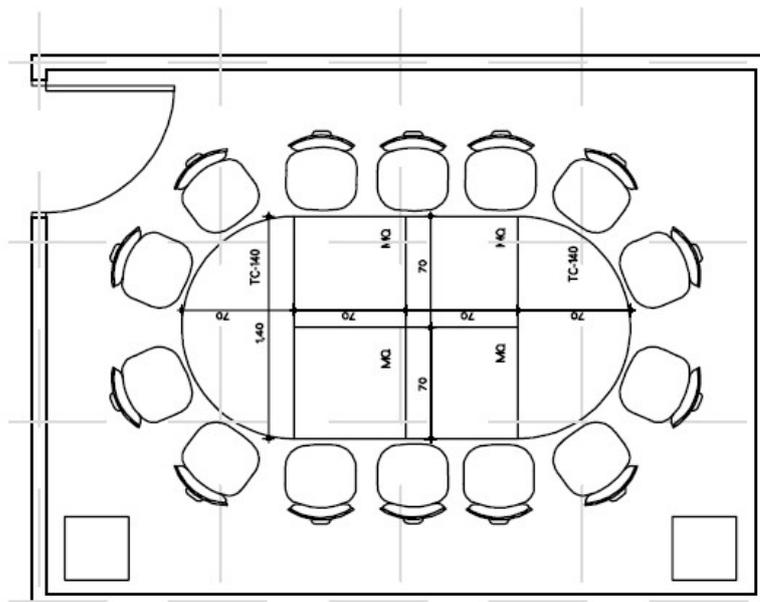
Planta baixa sala assessoria técnica. Área aproximada: 10m<sup>2</sup> (Fonte: Plano Diretor|CAFF)
